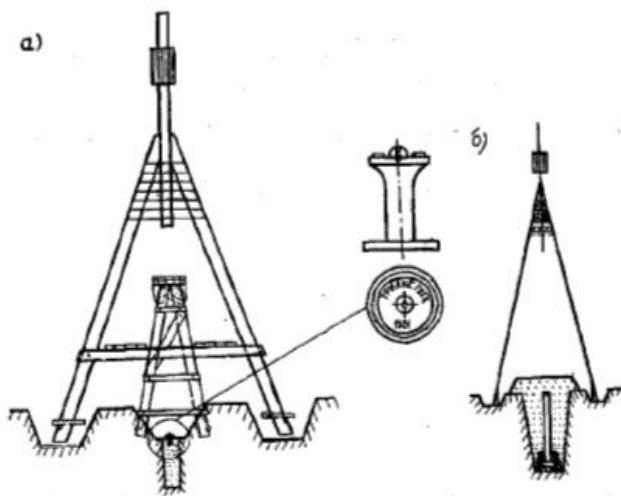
схема пункта ГГс: а) простой сигнал и железобетонный монолит; б) пирамида и трубчатый центр с железобетонным якорем.
